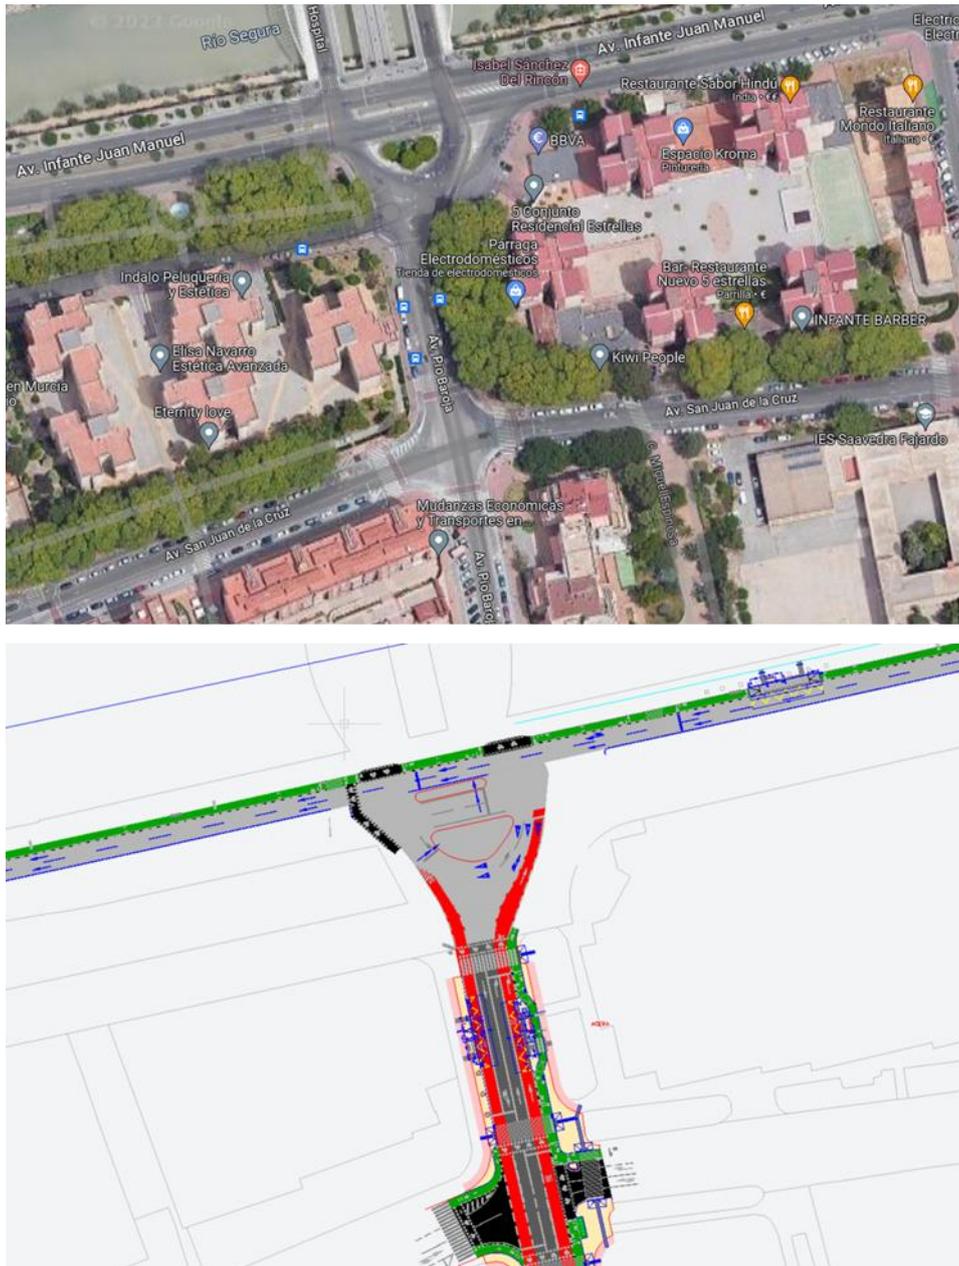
Detalle de la solución en la Avda. Pío Baroja (lote 6).
